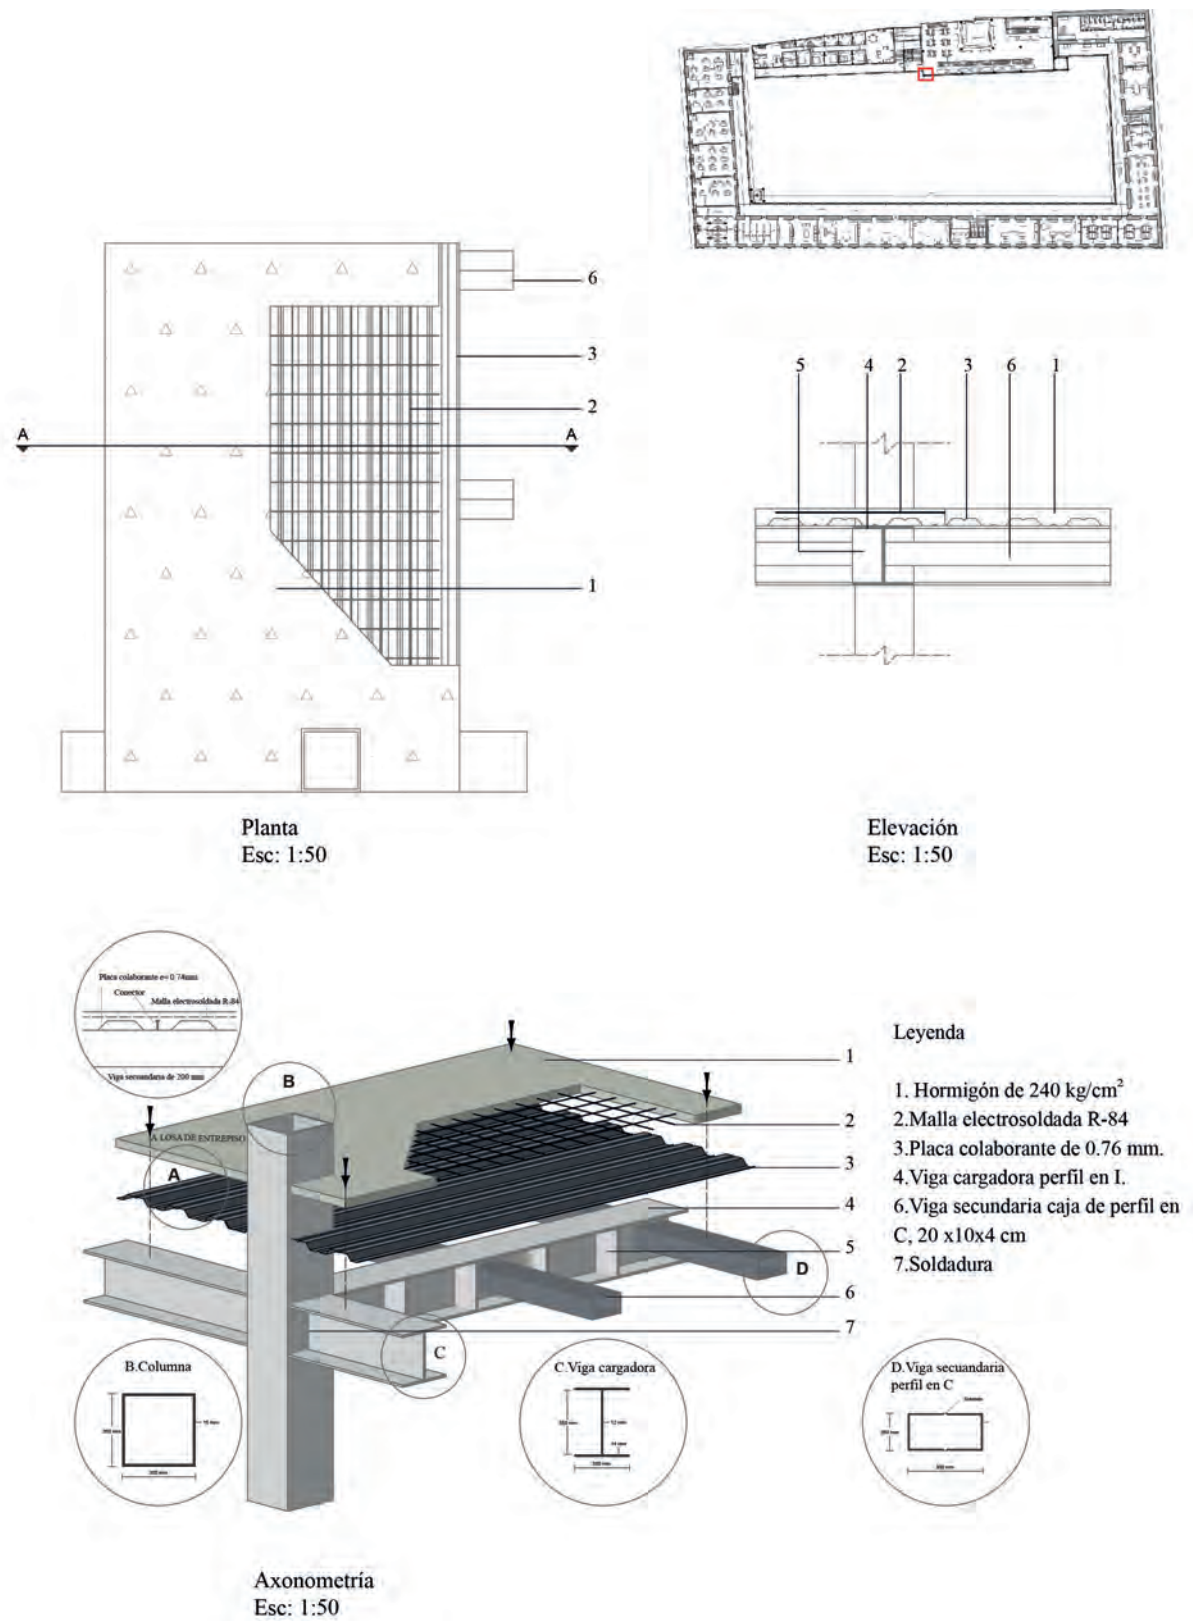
Detalle constructivo de losa colaborante. Fuente y elaboración: propia.
